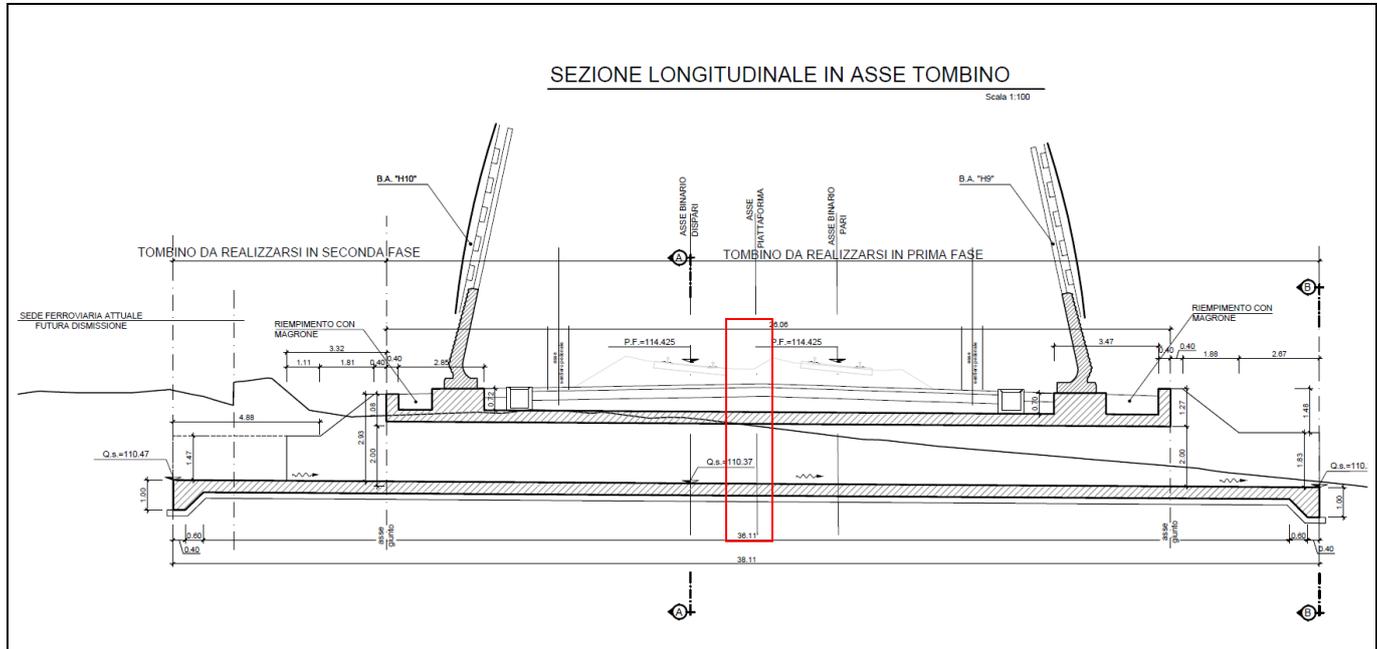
Sezione longitudinale e individuazione delle sezioni SC1 oggetto di verifica.
